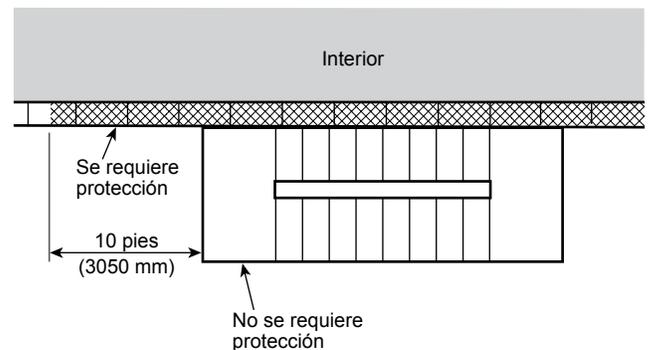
(b) Escalera con perímetro exterior no protegido que sobresale del muro exterior del edificio.
